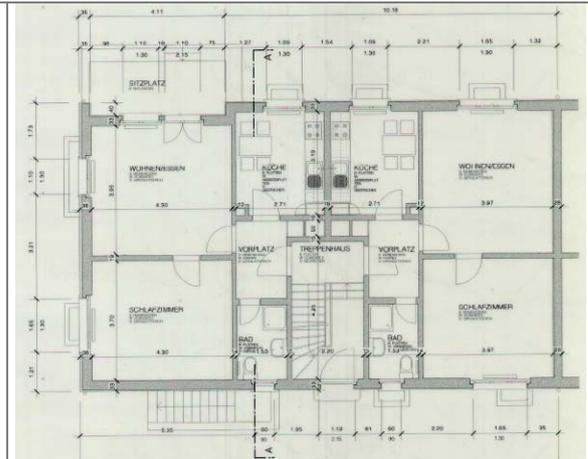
Grundriss EG [Quelle: Stadt Thun]⁴²
